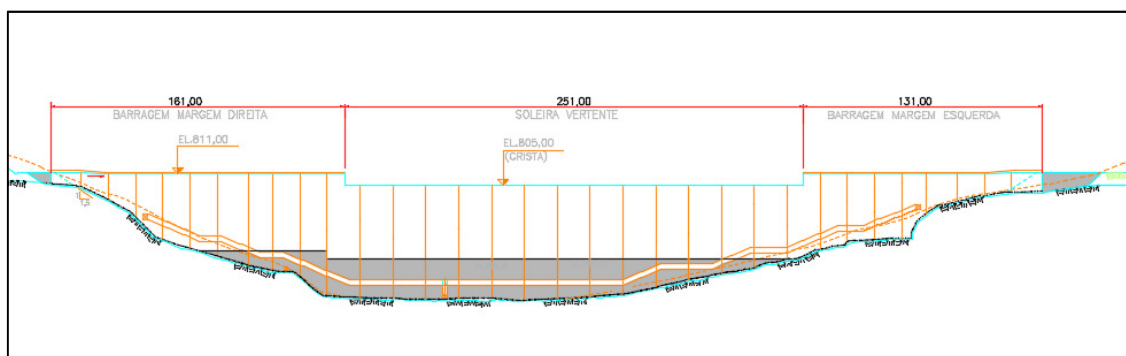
Vista de jusante da barragem e da soleira vertente.
